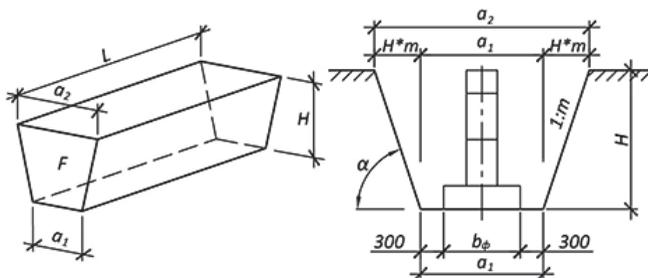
Схема траншеи (котлована) с боковыми откосами
